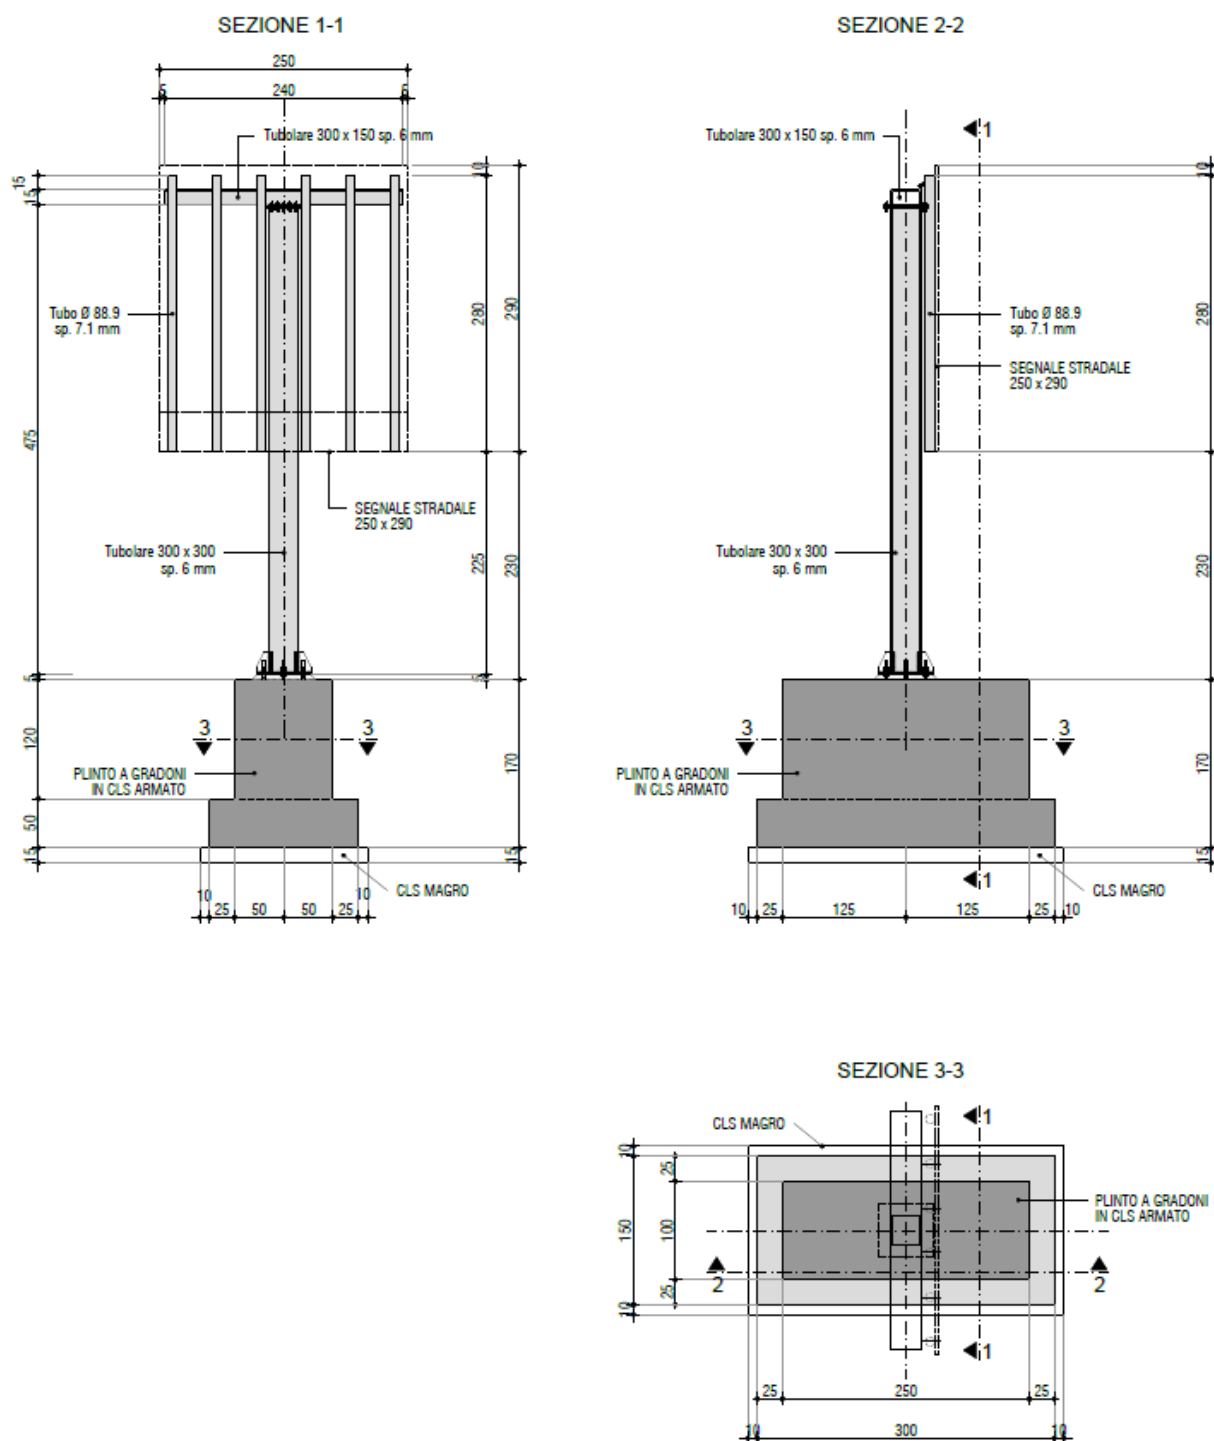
SEGNALE TIPO 1– FONDAZIONI E ELEVAZIONI
